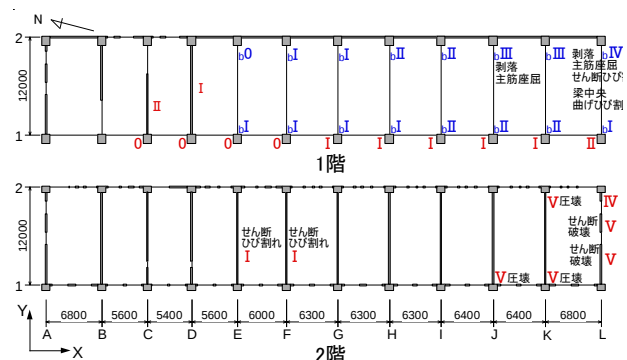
対象建物の平面図（梁間方向の損傷度を記載）
